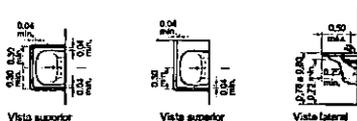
Exemplos de instalação de barras junto ao lavatório
